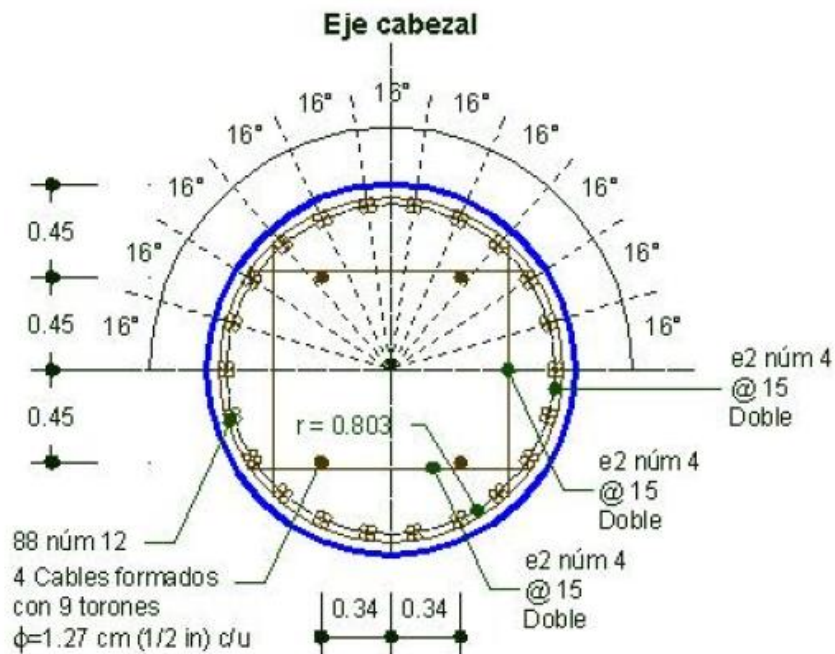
Columna de concreto reforzado y postensado [Sánchez y Cruz, 2005].
